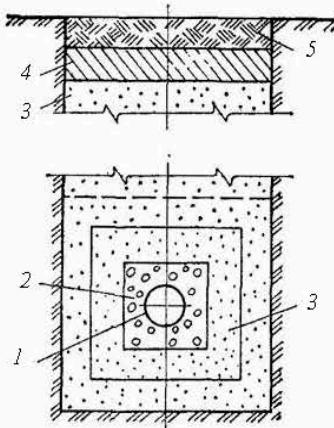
Трубчатый водозабор в траншее с вертикальными стенками в поперечном и продольном разрезах по оси водозабора:
